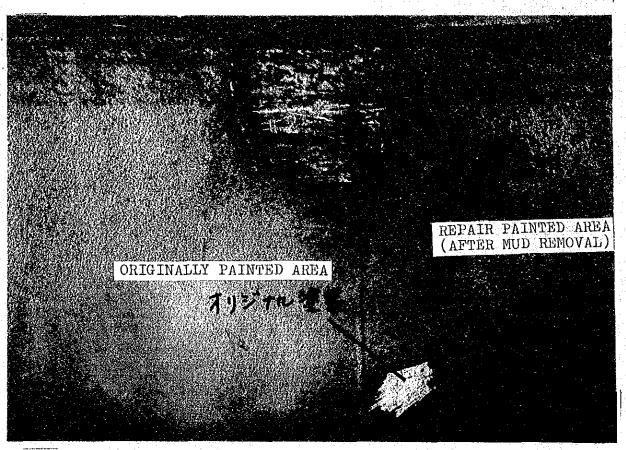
ドラフトケュウブ状況 (2号核) PHOTO-3 DRAFT TUBE INSIDE WALL (UNIT NO. 2)
